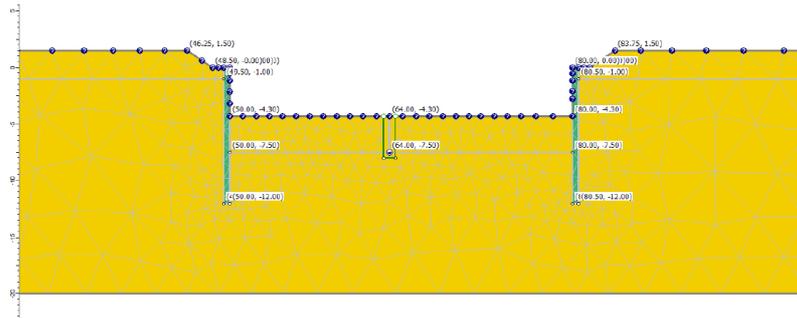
sezione del modello di calcolo nella fase di scavo "completo" fino ad estradosso solettone di fondazione, a seguito dell'installazione del sistema well point
